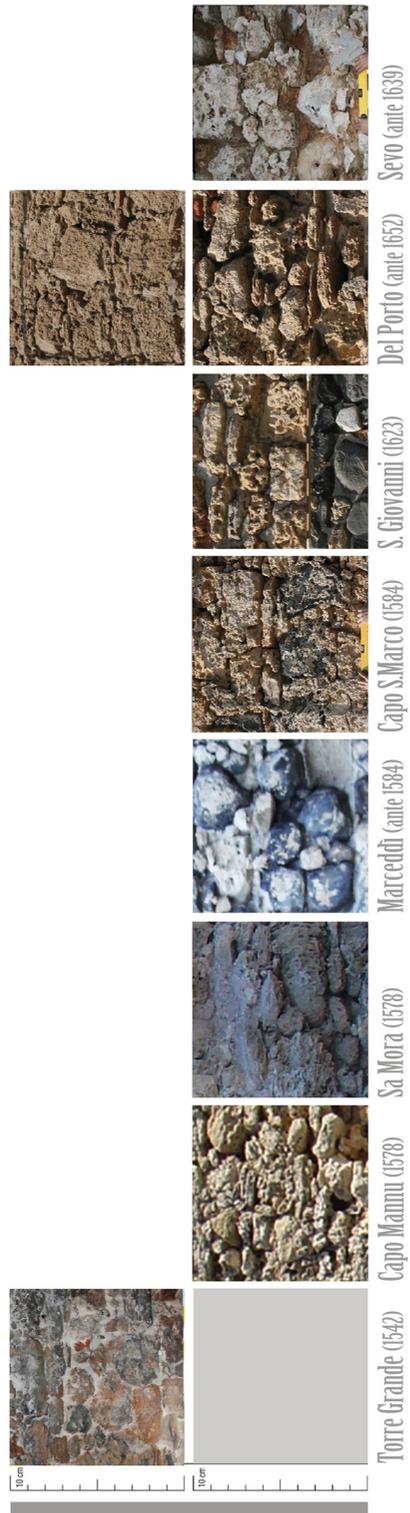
Campione murario. Fotoraddrizzamento e rilievo architettonico.
